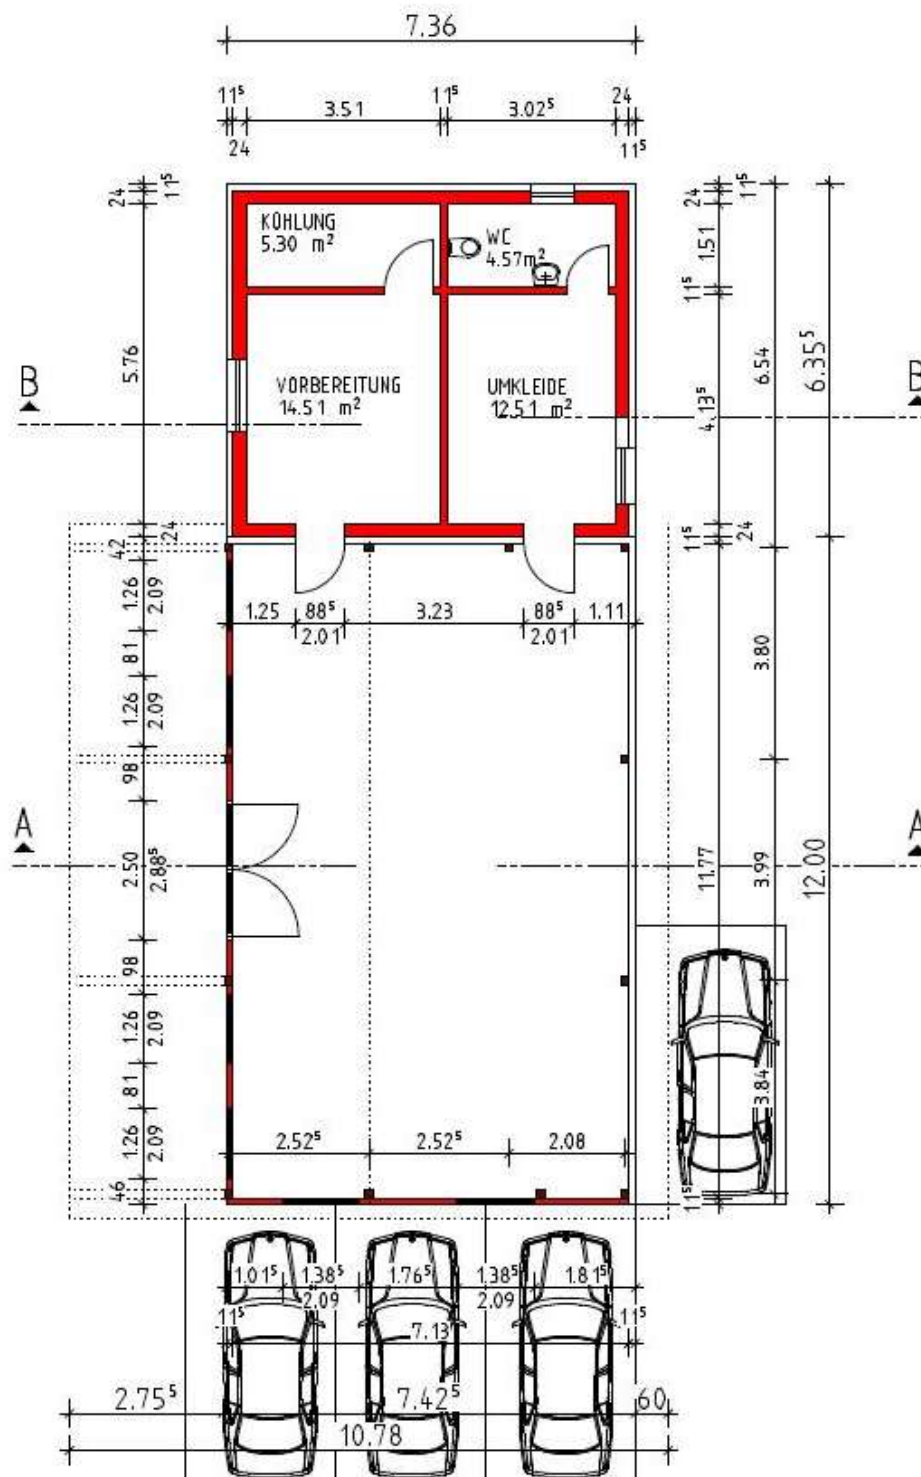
Grundriss mit Anbau (Quelle: Ingenieurbüro Holst) (Nicht genordet)
